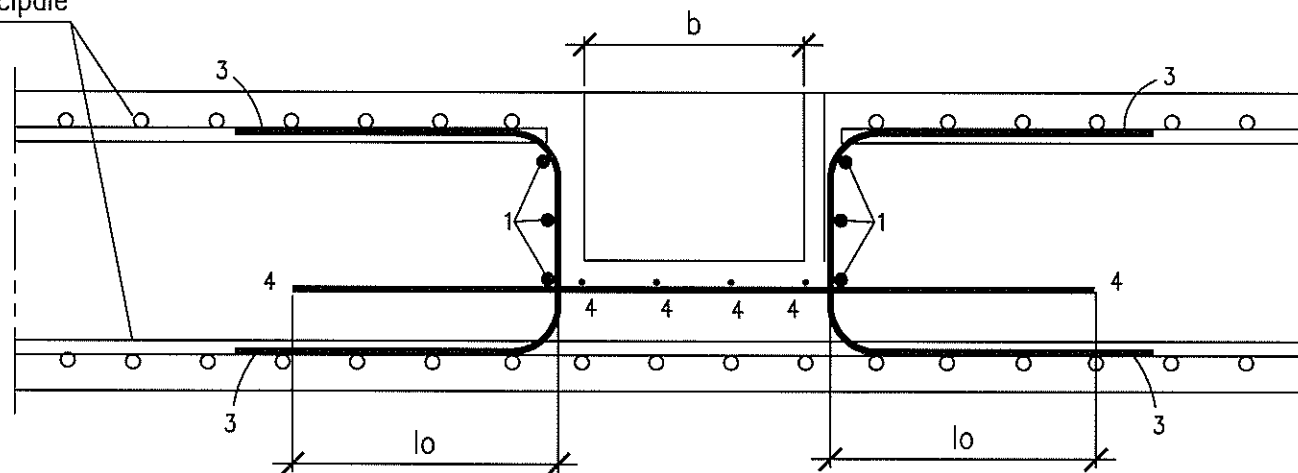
DETAIL DE RENFORTS DES DECAISSES DANS DALLES VUE EN PLAN Décaissés simples
